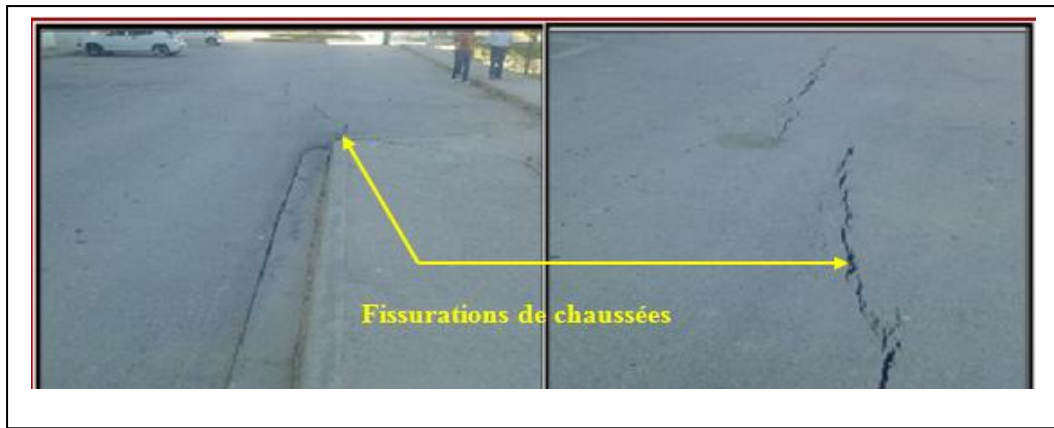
Fissure de la chaussée dans le sens longitudinal
